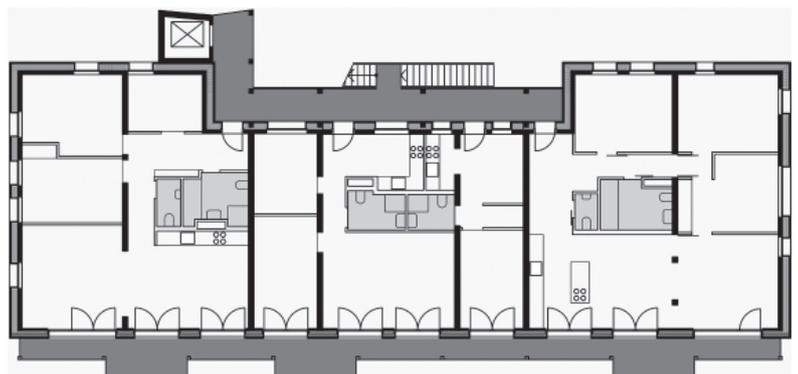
Beispielgrundriss 1. Obergeschoss
